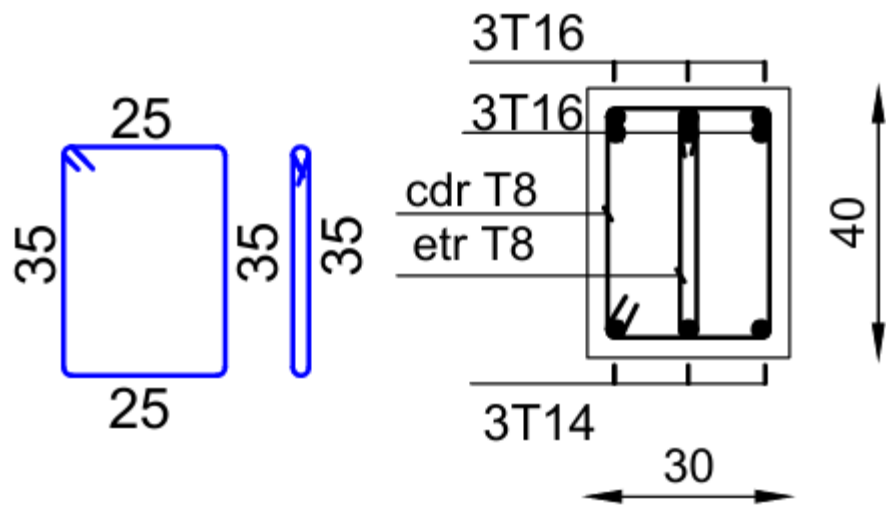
Schéma de ferrailage de poutre aux appuis.
